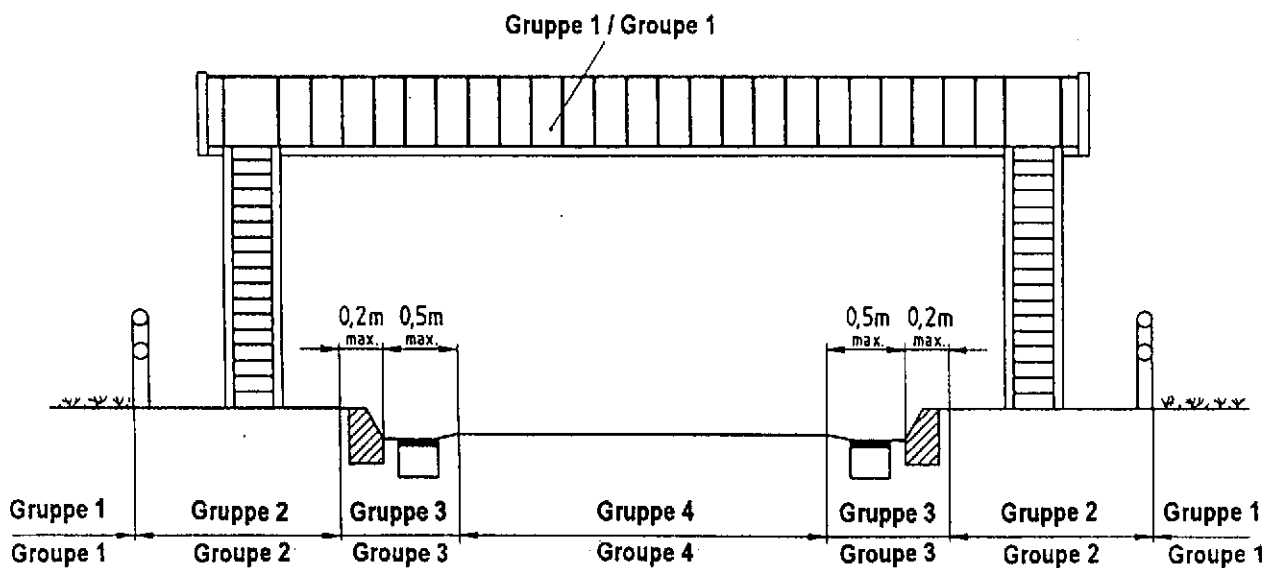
Typischer Querschnitt einer Strasse mit Darstellung einiger Gruppen von Einbaustellen
